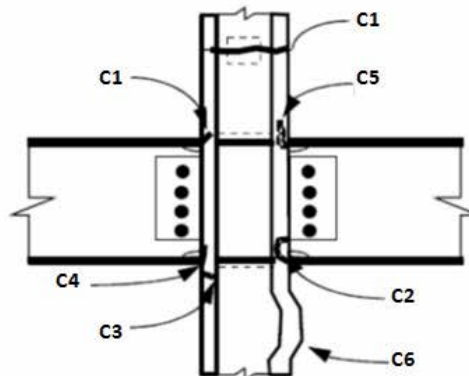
Tipos de daños en columnas (Fuente: FEMA 351).
